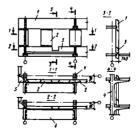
Фрягмент фасада каркасного эдания с панелями горизонтальной полосовой разрезки:
